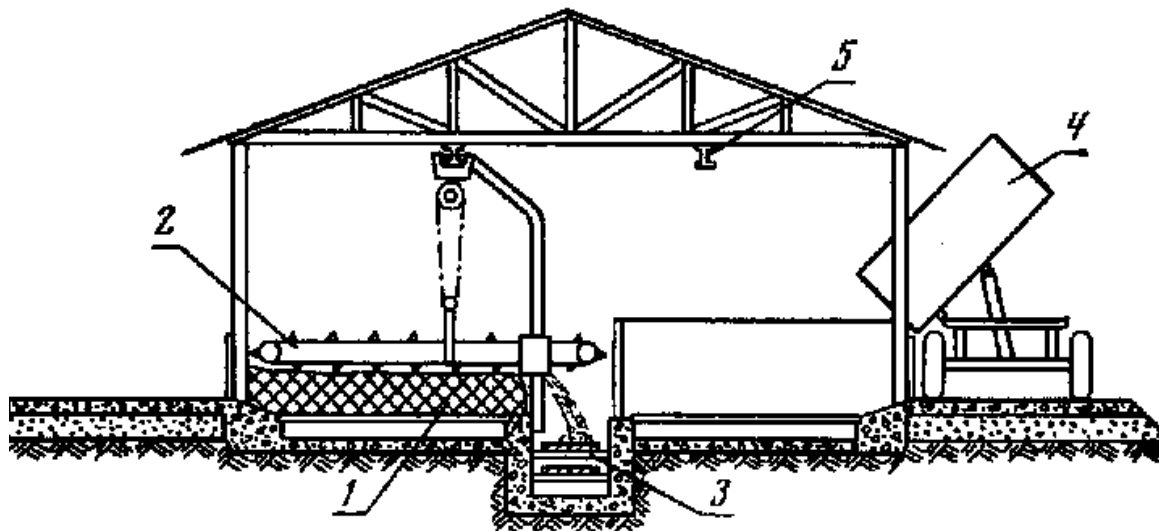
Схема пункта сушки и переработки льновороха на базе напольной сушилки: 1 - сушильная камера с ворохом; 2 - подвесной гребенчатый транспортёр; 3 - центральный ленточный транспортёр; 4 - тракторный прицеп с ворохом; 5 - монорельс
